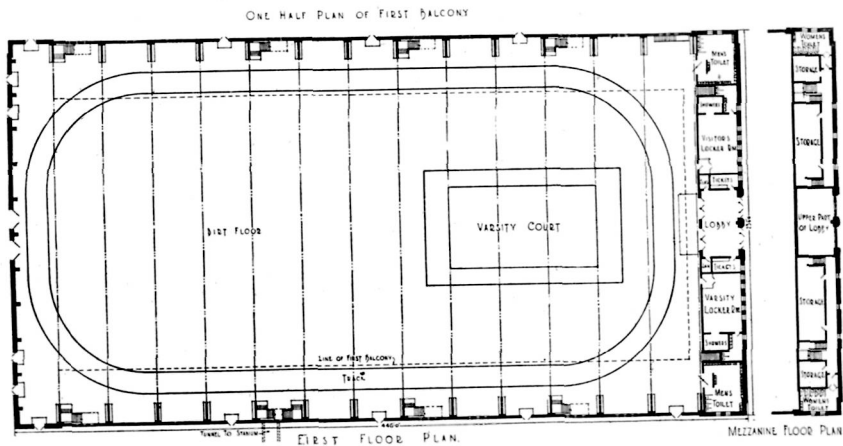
u. 161. Field-House, Minnesota-University. Grundrisse
